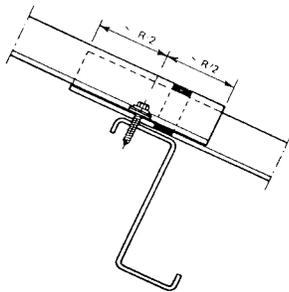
Complément d'étanchéité - Pose avec fixations en plage
